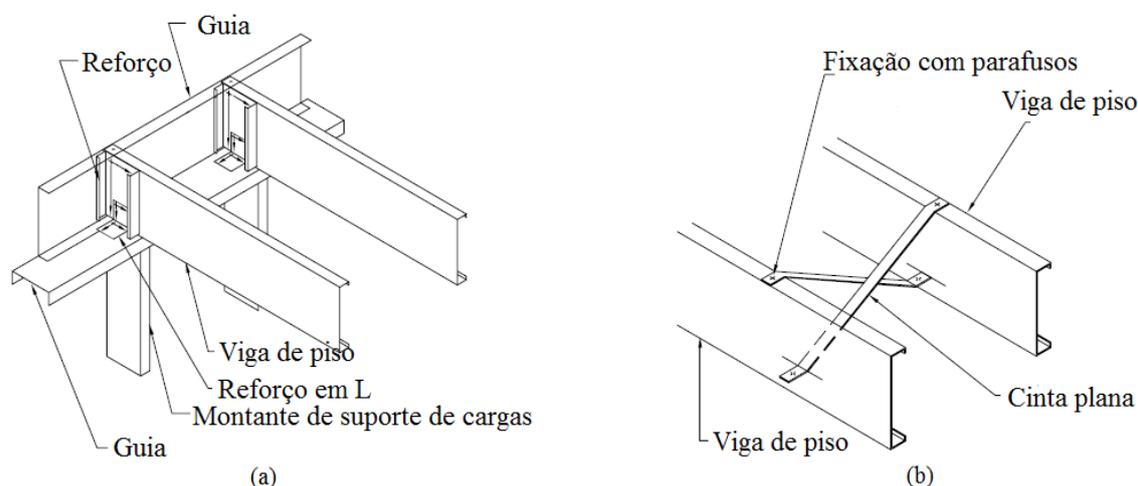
Pormenores construtivos das lajes: (a) reforços com cantoneira em L; (b) contraventamento em X (NASFA, 2000)
